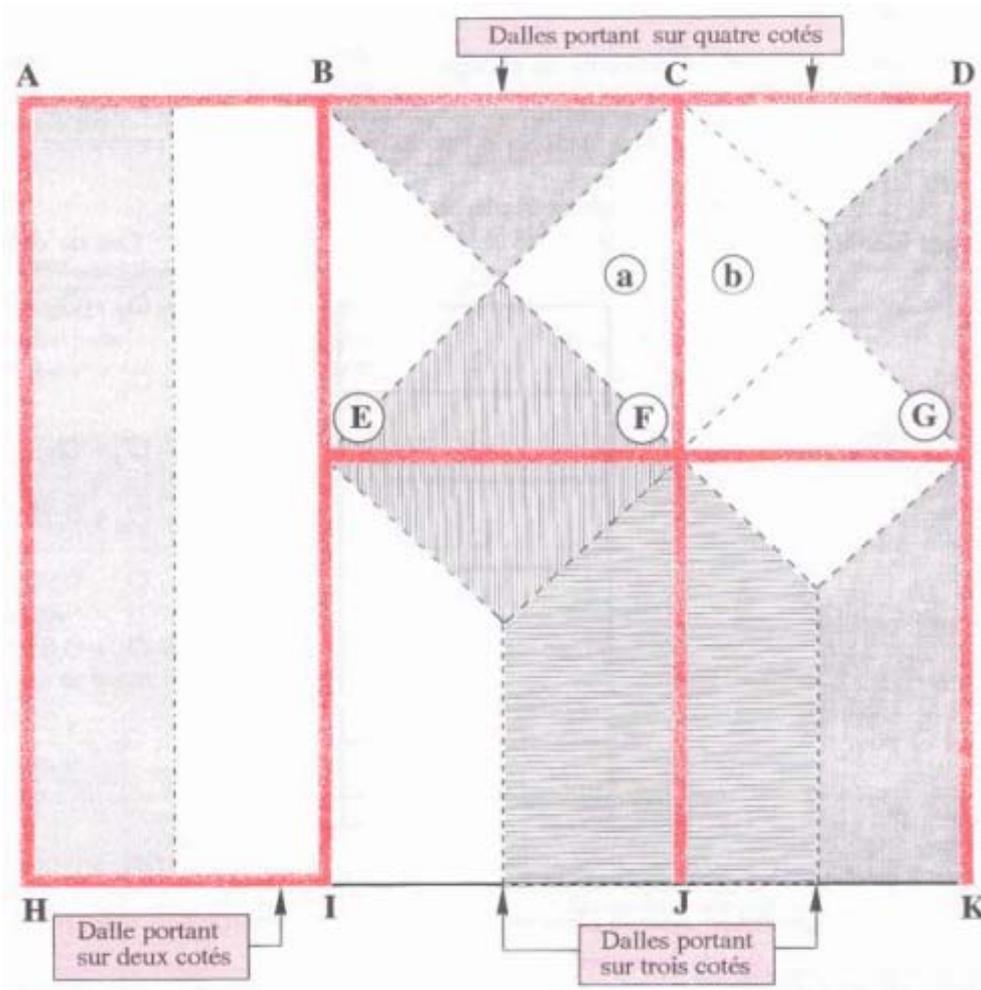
Etendue d'influence d'un plancher à structure mixte.
